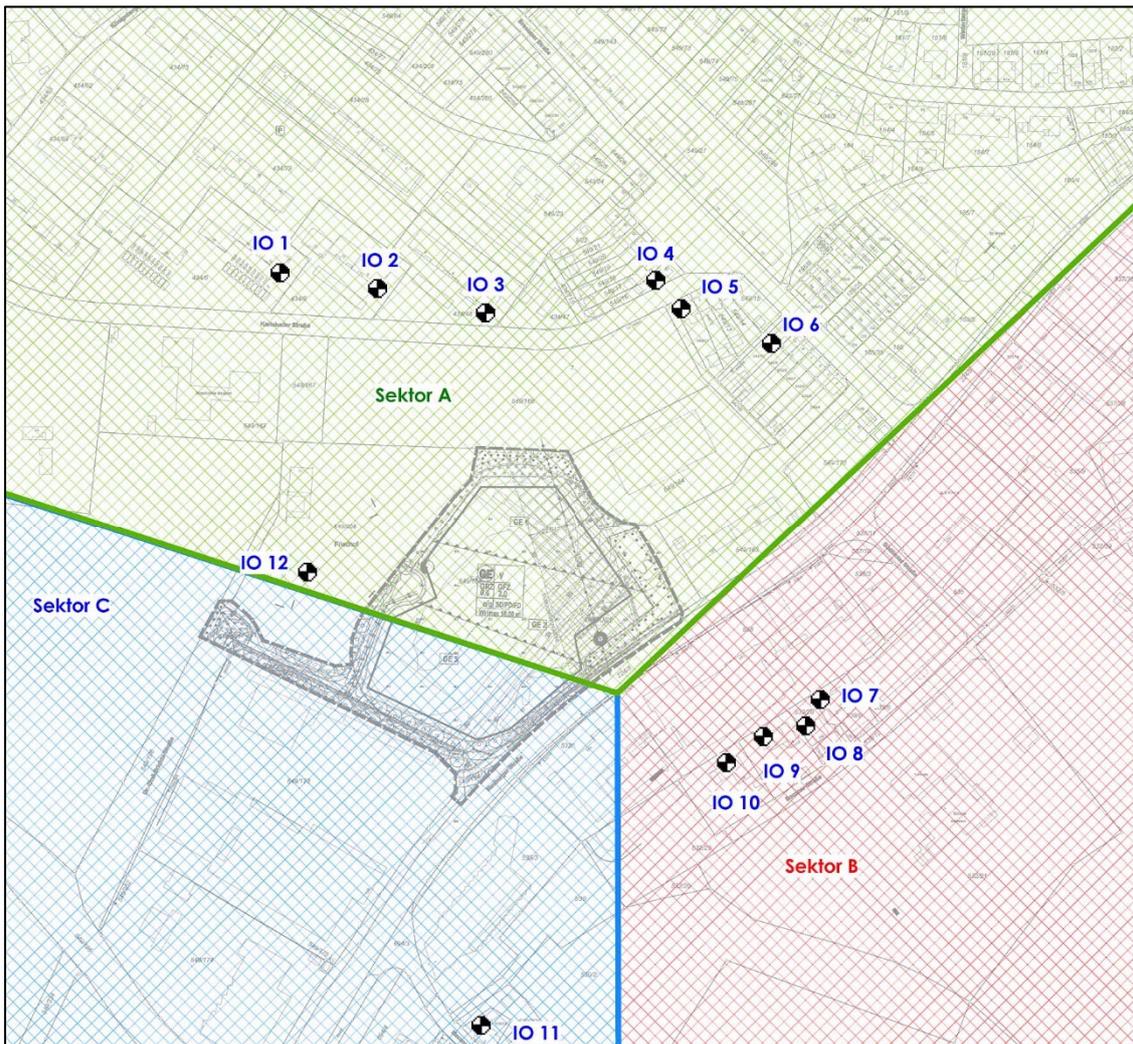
Lageplan mit Darstellung der Richtungssektoren
